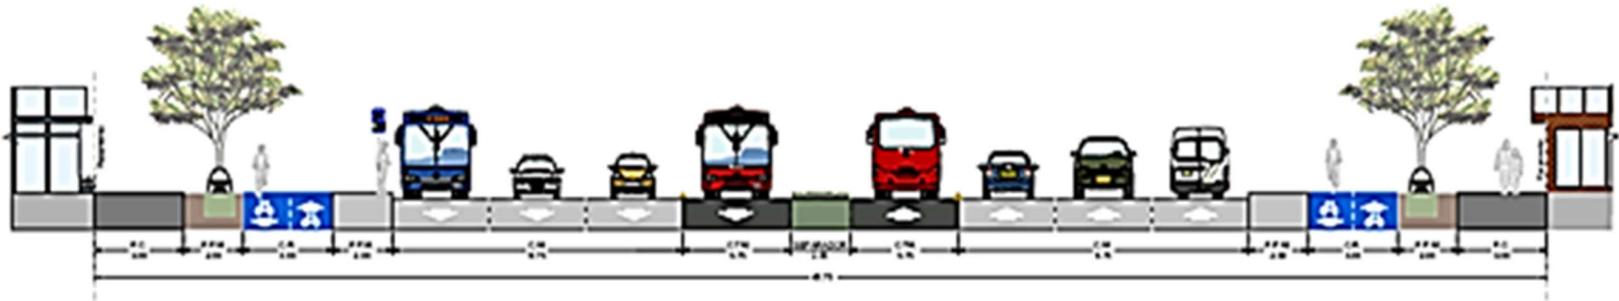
Sección vial entre estaciones Av. Calle 66A – Av. Av. Calle 80
